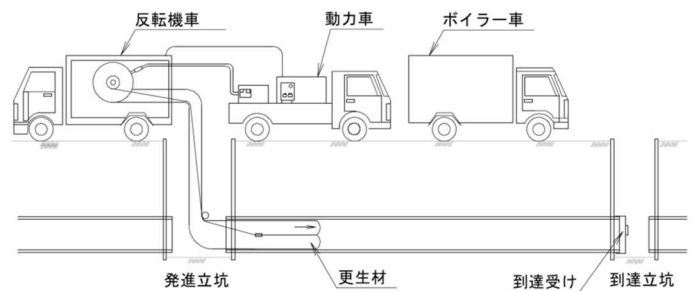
反転工法（熱硬化タイプ）の施工概要(例)
